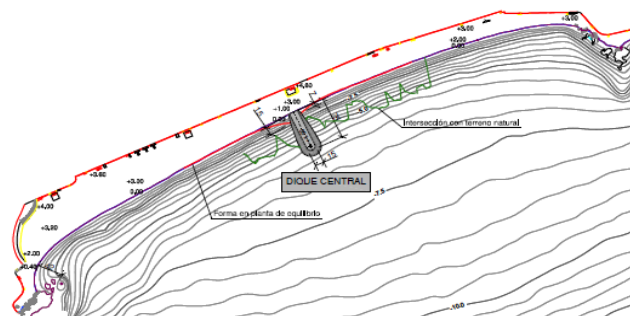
Configuració en planta de l'alternativa 4. En vermell s'observa la planta d'equilibri (Iberport Consulting, 2008)
